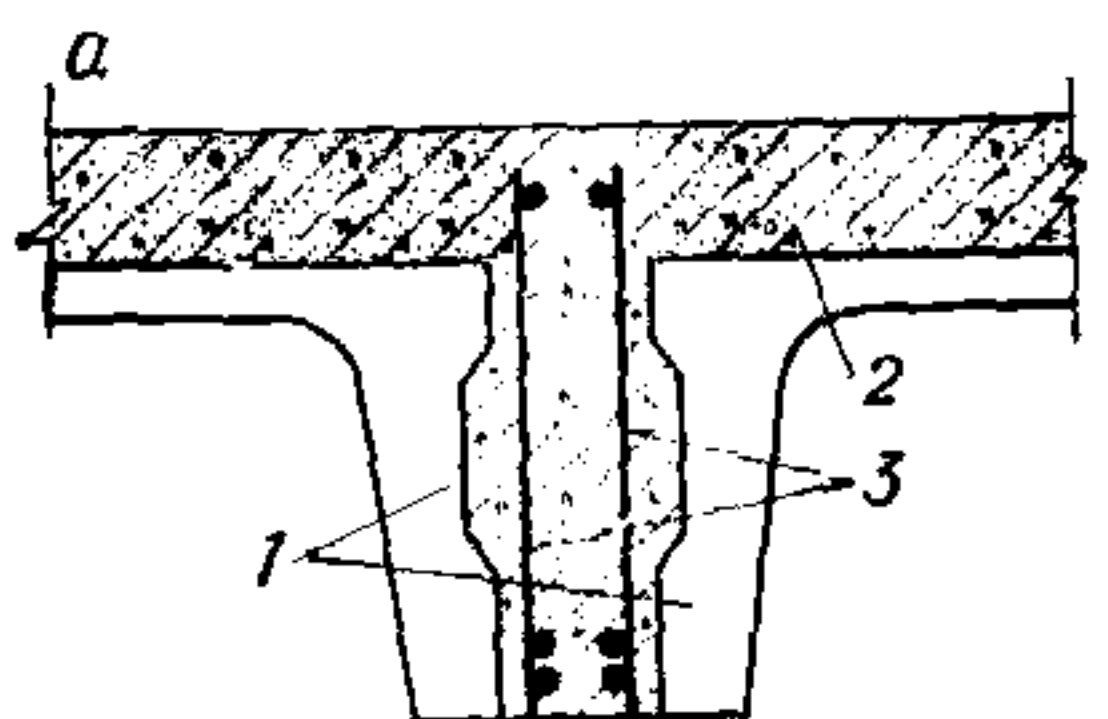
Схема размещения арматурных каркасов между сборными элементами сборно-монолитного перекрытия убежища
